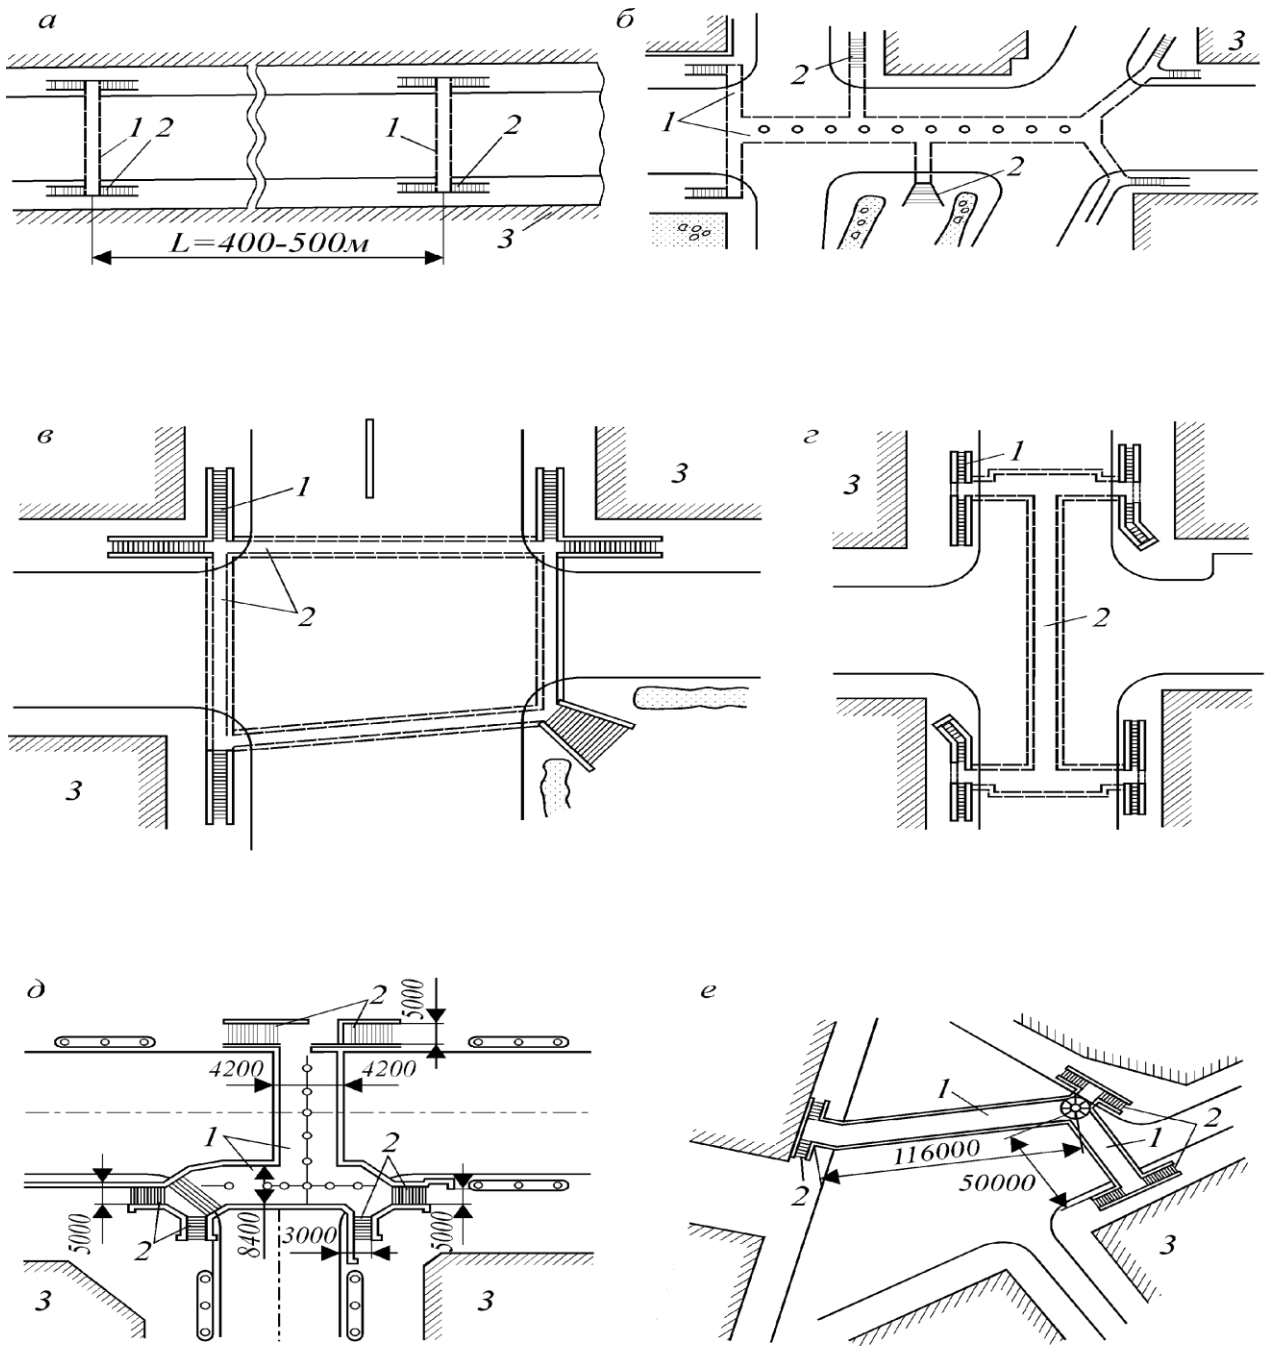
Планувальні схеми пішохідних тунелів: *а, б* – трасою автомагістралей: 1 – тунель, 2 – сходи, 3 – забудова; *в, г* – на прямому перехресті: 1 – сходи, 2 – тунель, 3 – забудова; *д* – на Т-подібному перехресті; *е* – на трикутному перехресті: 1 – тунель, 2 – сходи, 3 – забудова
